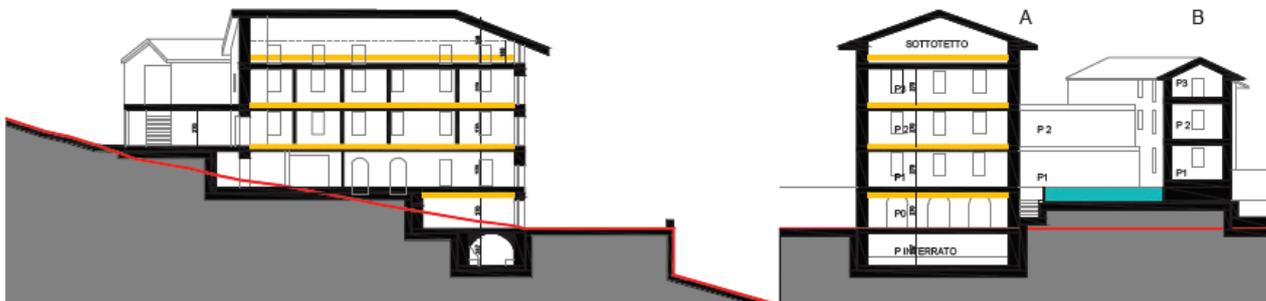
Struttura Paradiso, distribuzione dei piani.
